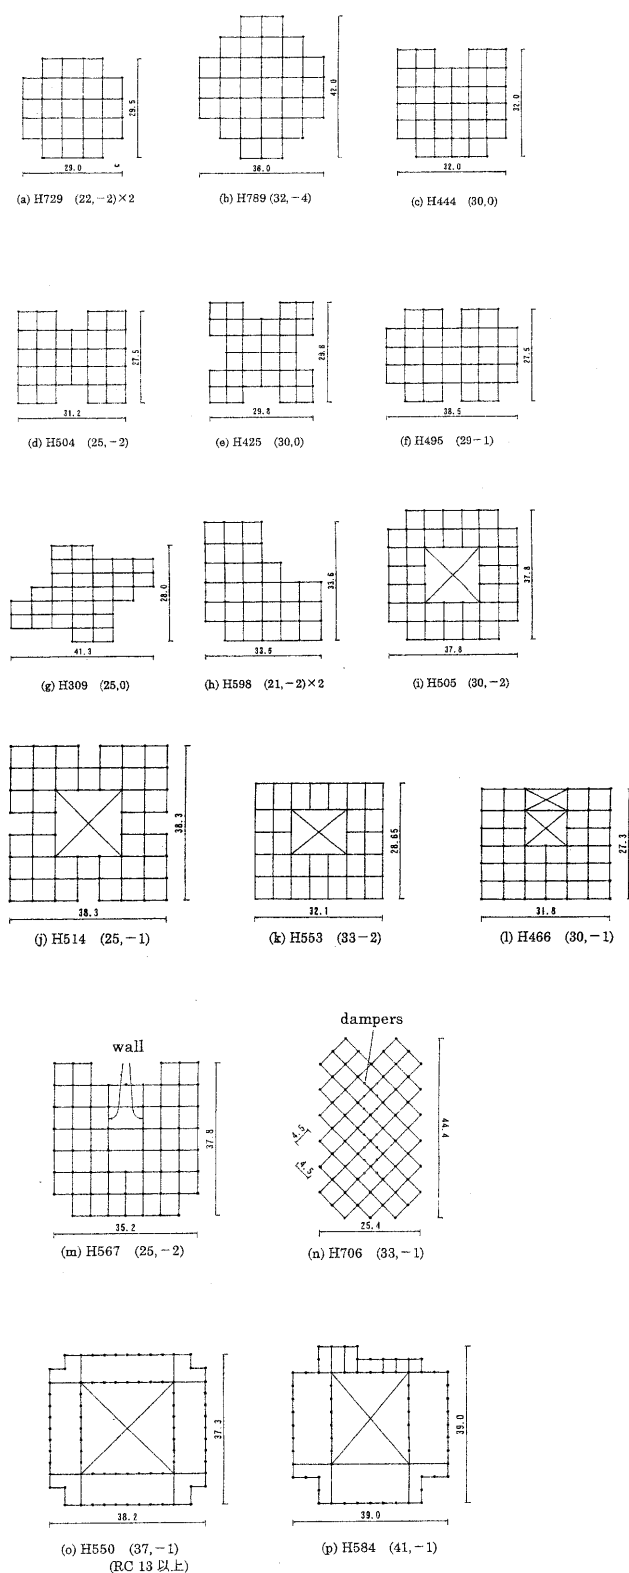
高層鋼筋混凝土建築物主要之結構平面
